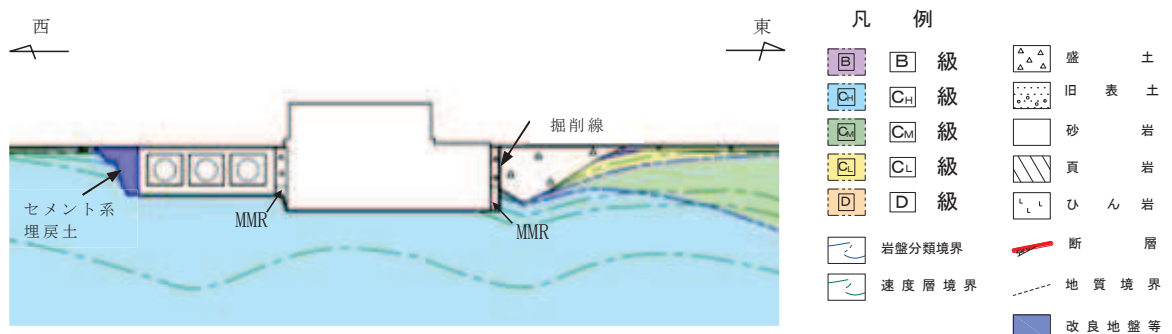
(1) 緊急用電気品建屋の地質断面図 (⑧-⑧断面)
